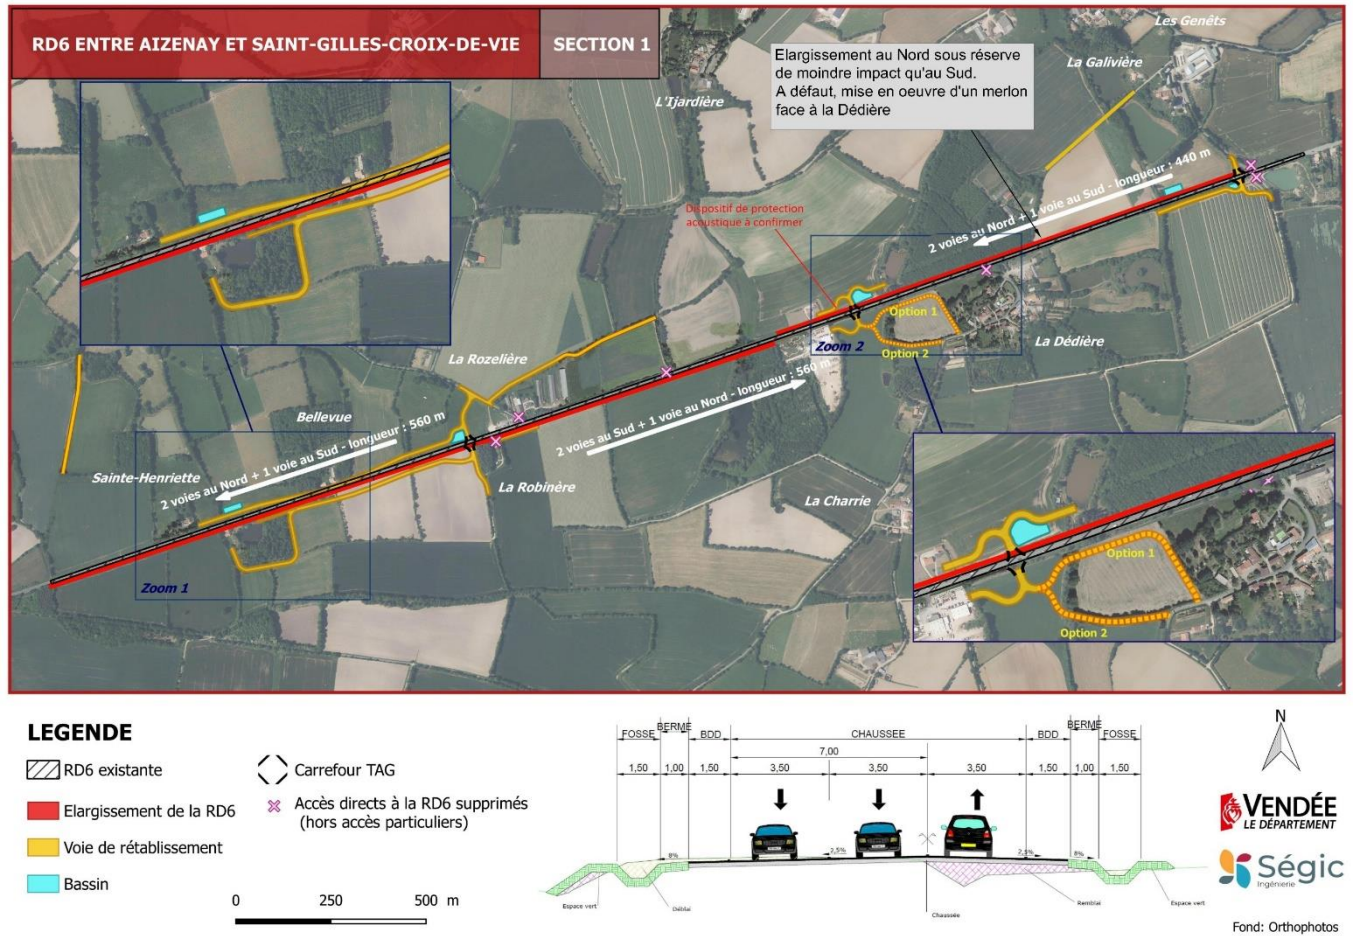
Plan de la section 1 retenu à l'issue de la concertation
